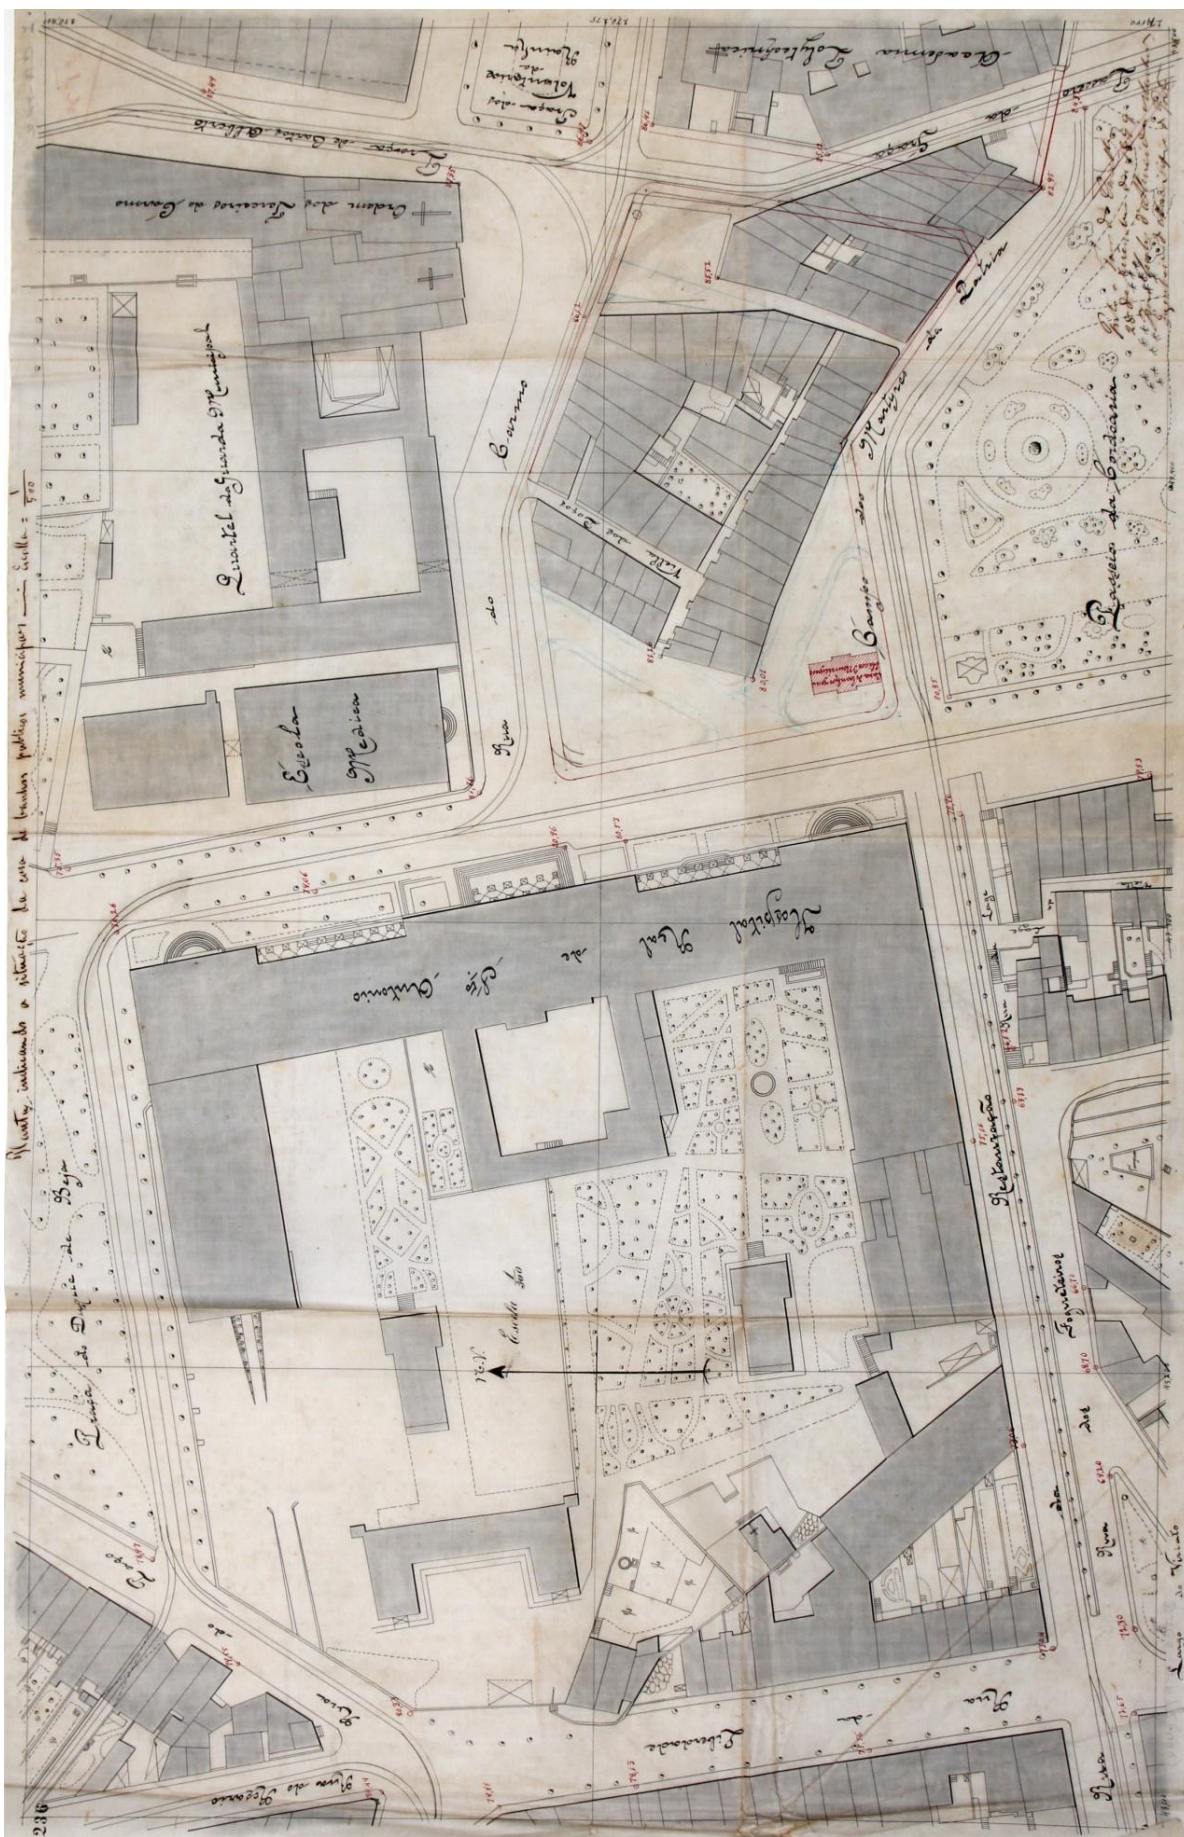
Planta com a localização a vermelho da implantação do balneário.
